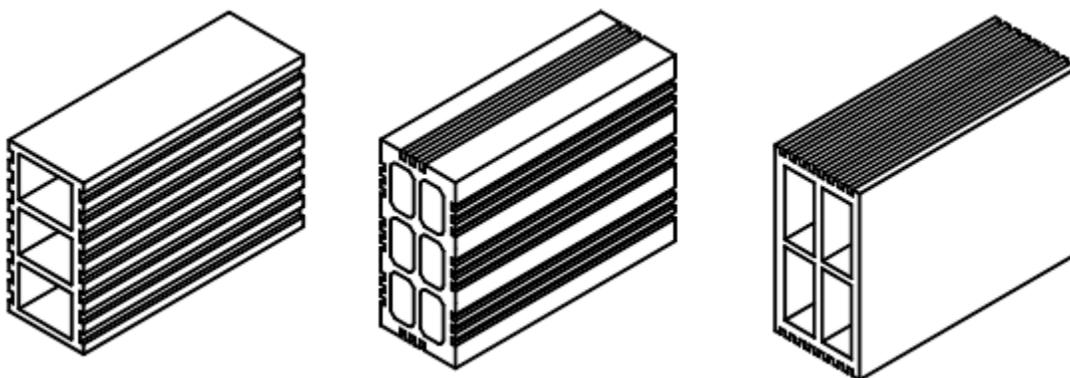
Unidades de mampostería de perforación horizontal (NTC 4205, 2000)
